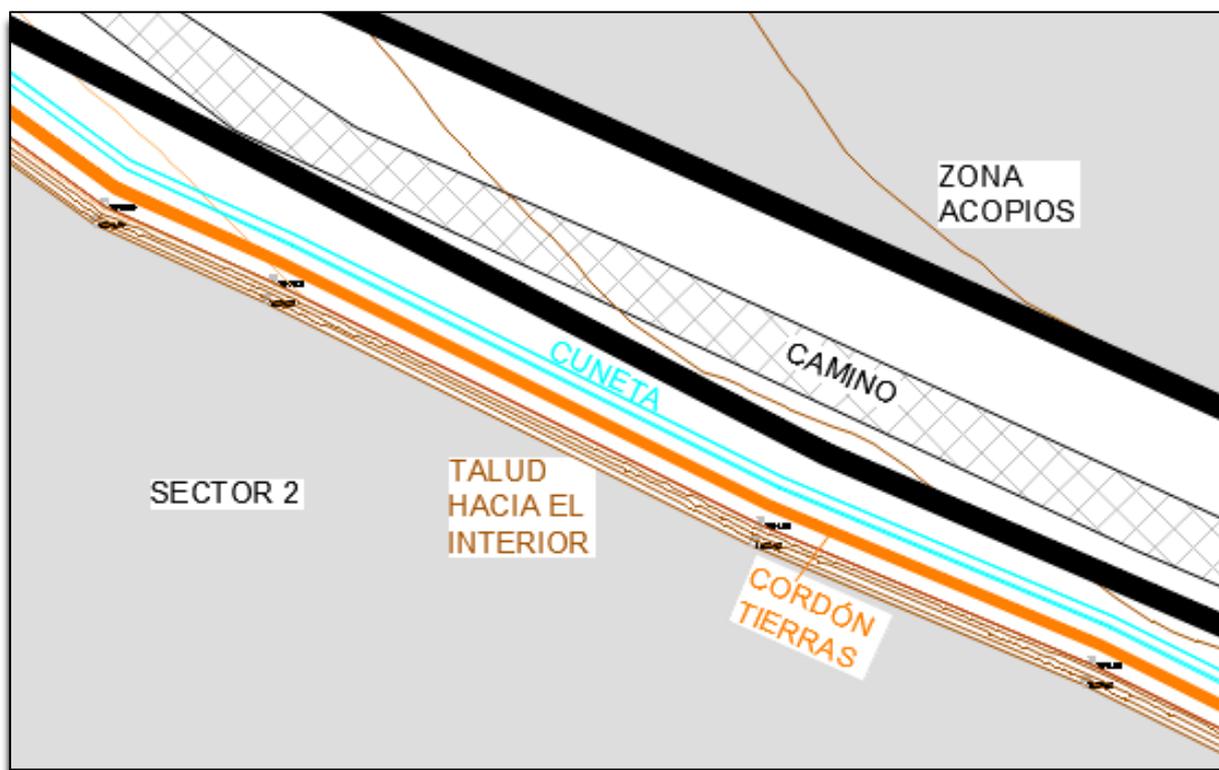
Esquema tipo del perímetro del hueco de excavación. planta.
